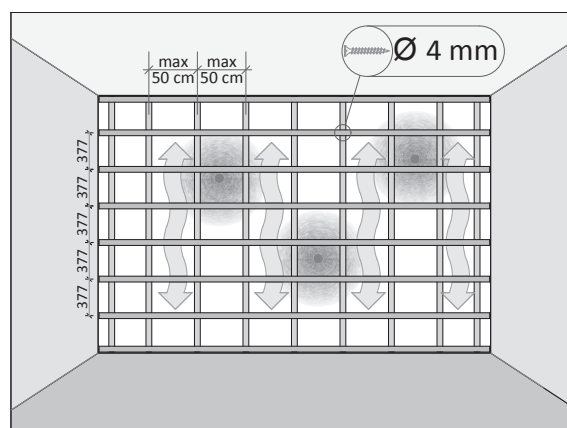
Монтаж первого элемента на планках – монтаж по горизонтали.
